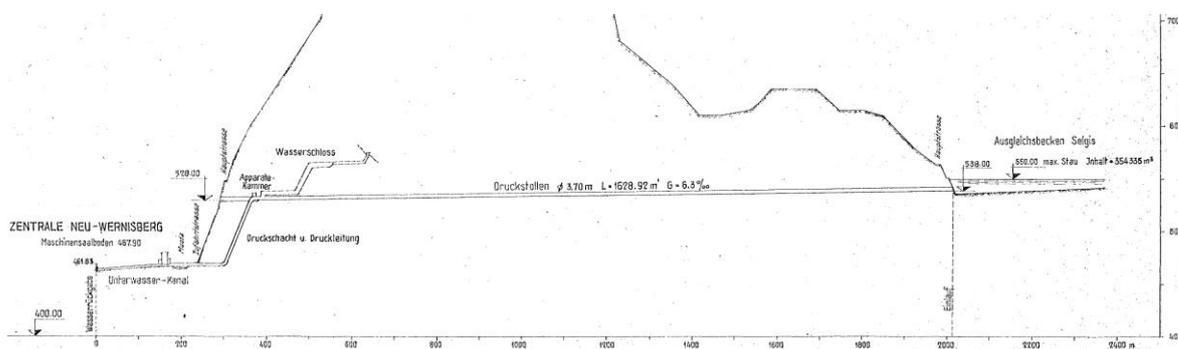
Längenprofil des Triebwassersystems (Ausschnitt aus Plan: 13_801)
